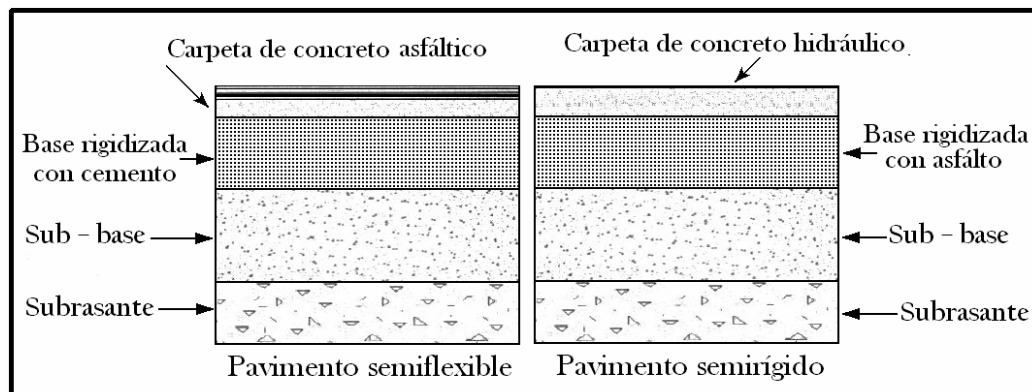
Capas que conforman un pavimento semiflexible y semirígido.
